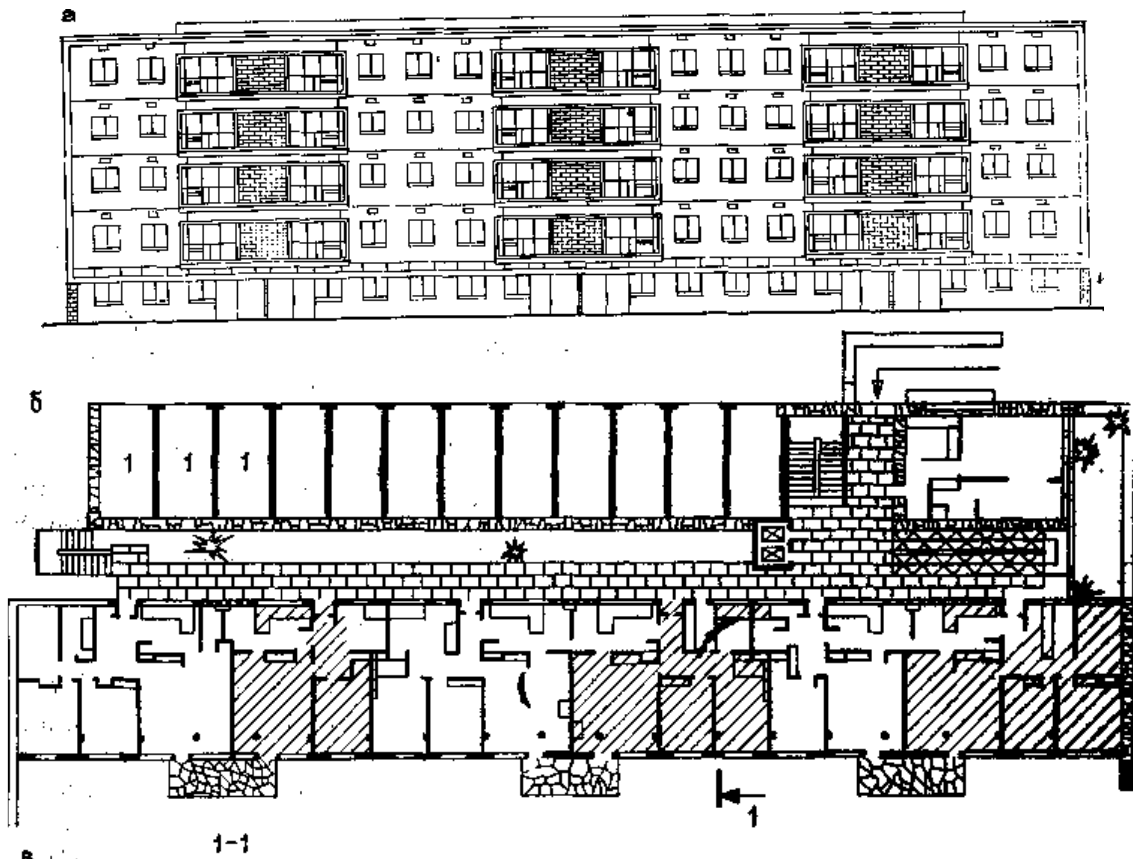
Галерейний будинок в Марокко: а — фасад; б — план першого поверху: 1 — гаражі; в — розріз.
